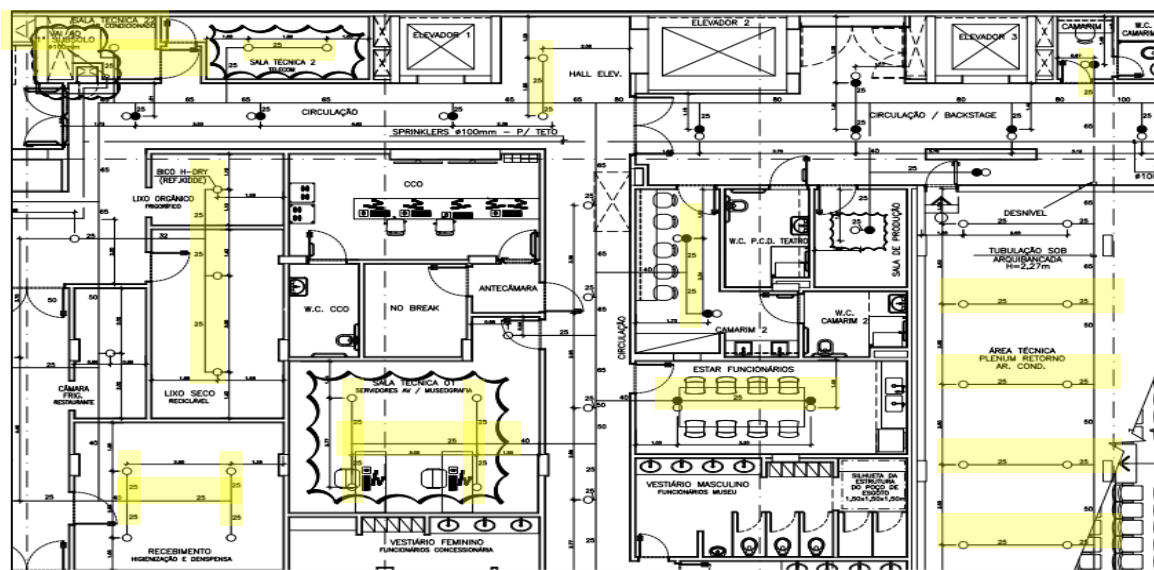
Demonstração da Patologia da Tubulação de aço galvanizado de 25 mm – 1º Subsolo
